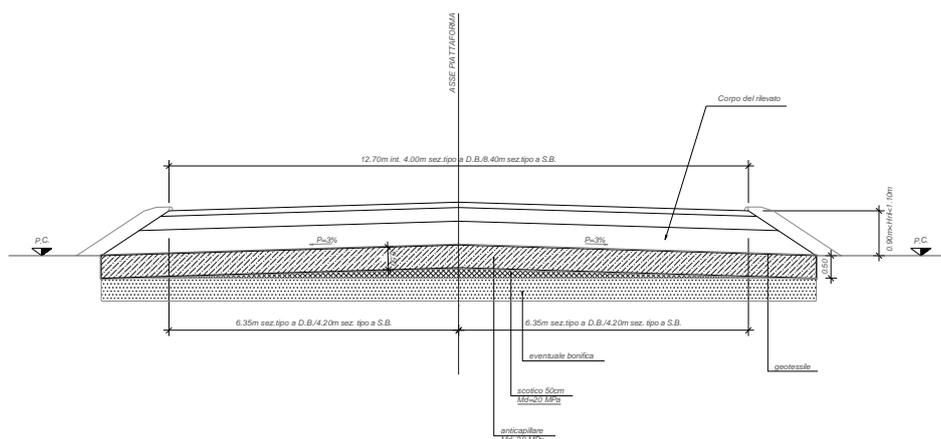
Strato di fondazione per rilevati  $0,90 \text{ m} \leq H_{ri} < 1,10$  m
